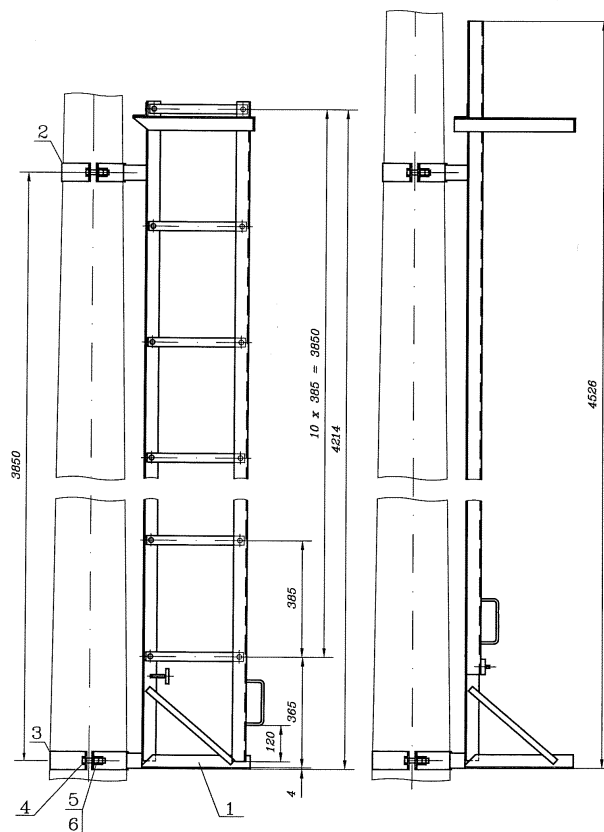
Лестница складная для металлических мачт (а) и для железобетонных мачт (б)
